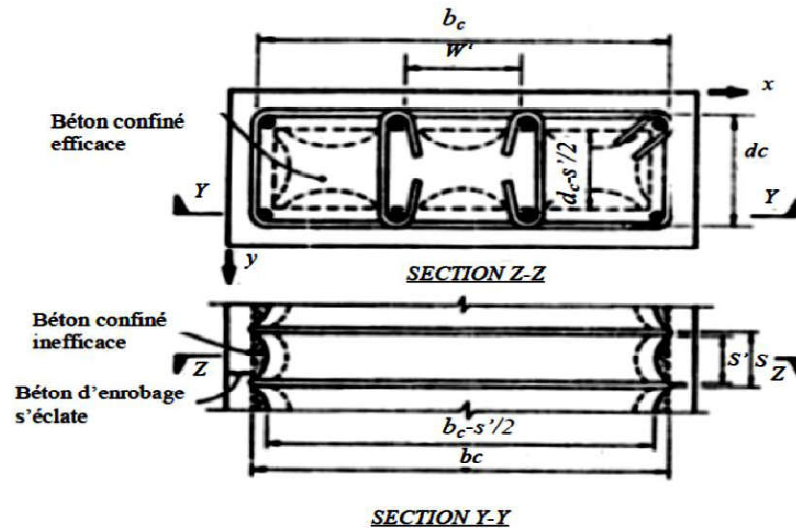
Béton de confinement efficace pour un ferrailage transversal rectangulaire
